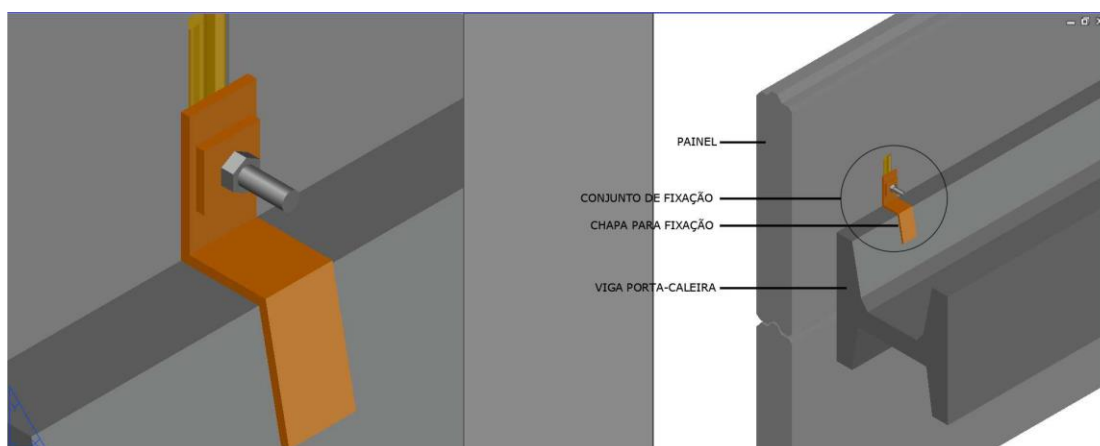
Pormenor de fixação de um painel pré-fabricado com uma viga caleira pré-fabricada (José Rui Pinto,2021)
